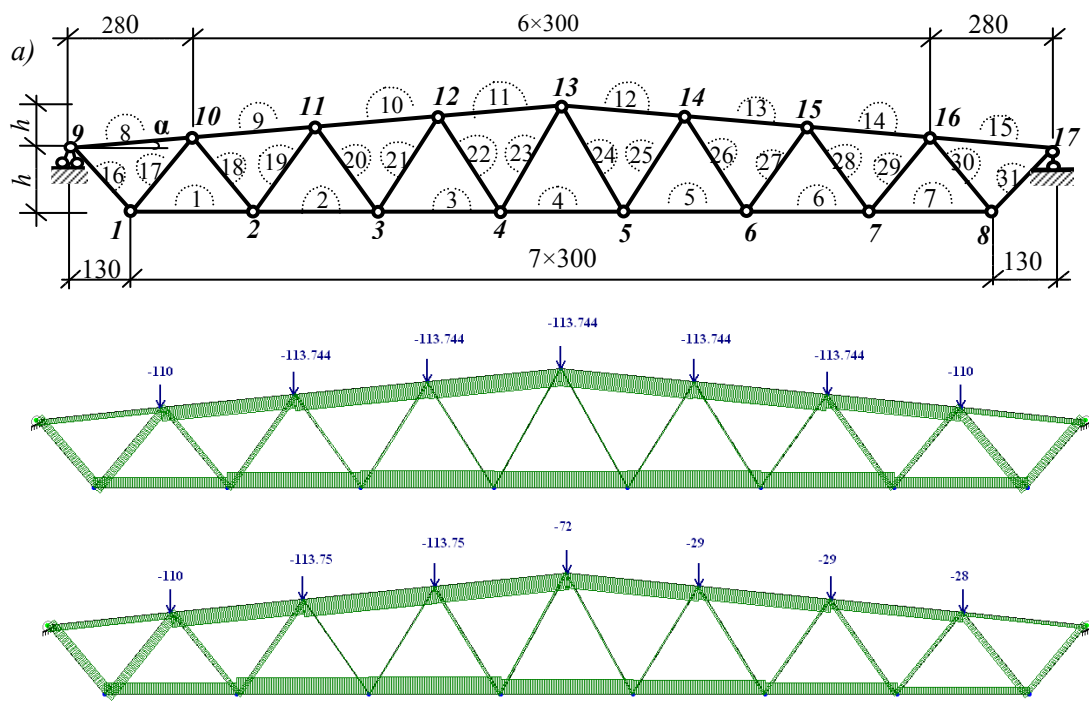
Расчетная схема фермы (а); результаты расчета при начальной геометрии в первом и втором нагружении (б)
